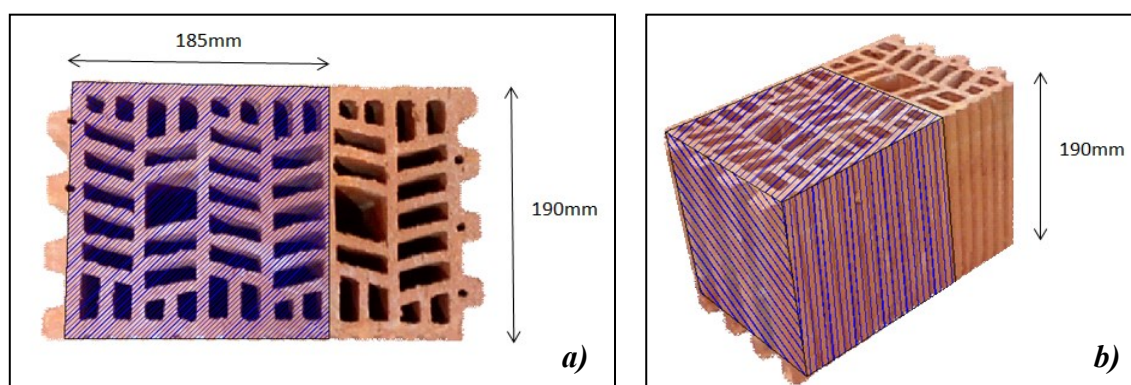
Dimensão dos provetes após o corte; a) Comprimento e largura dos provetes; b) Altura dos provetes.
